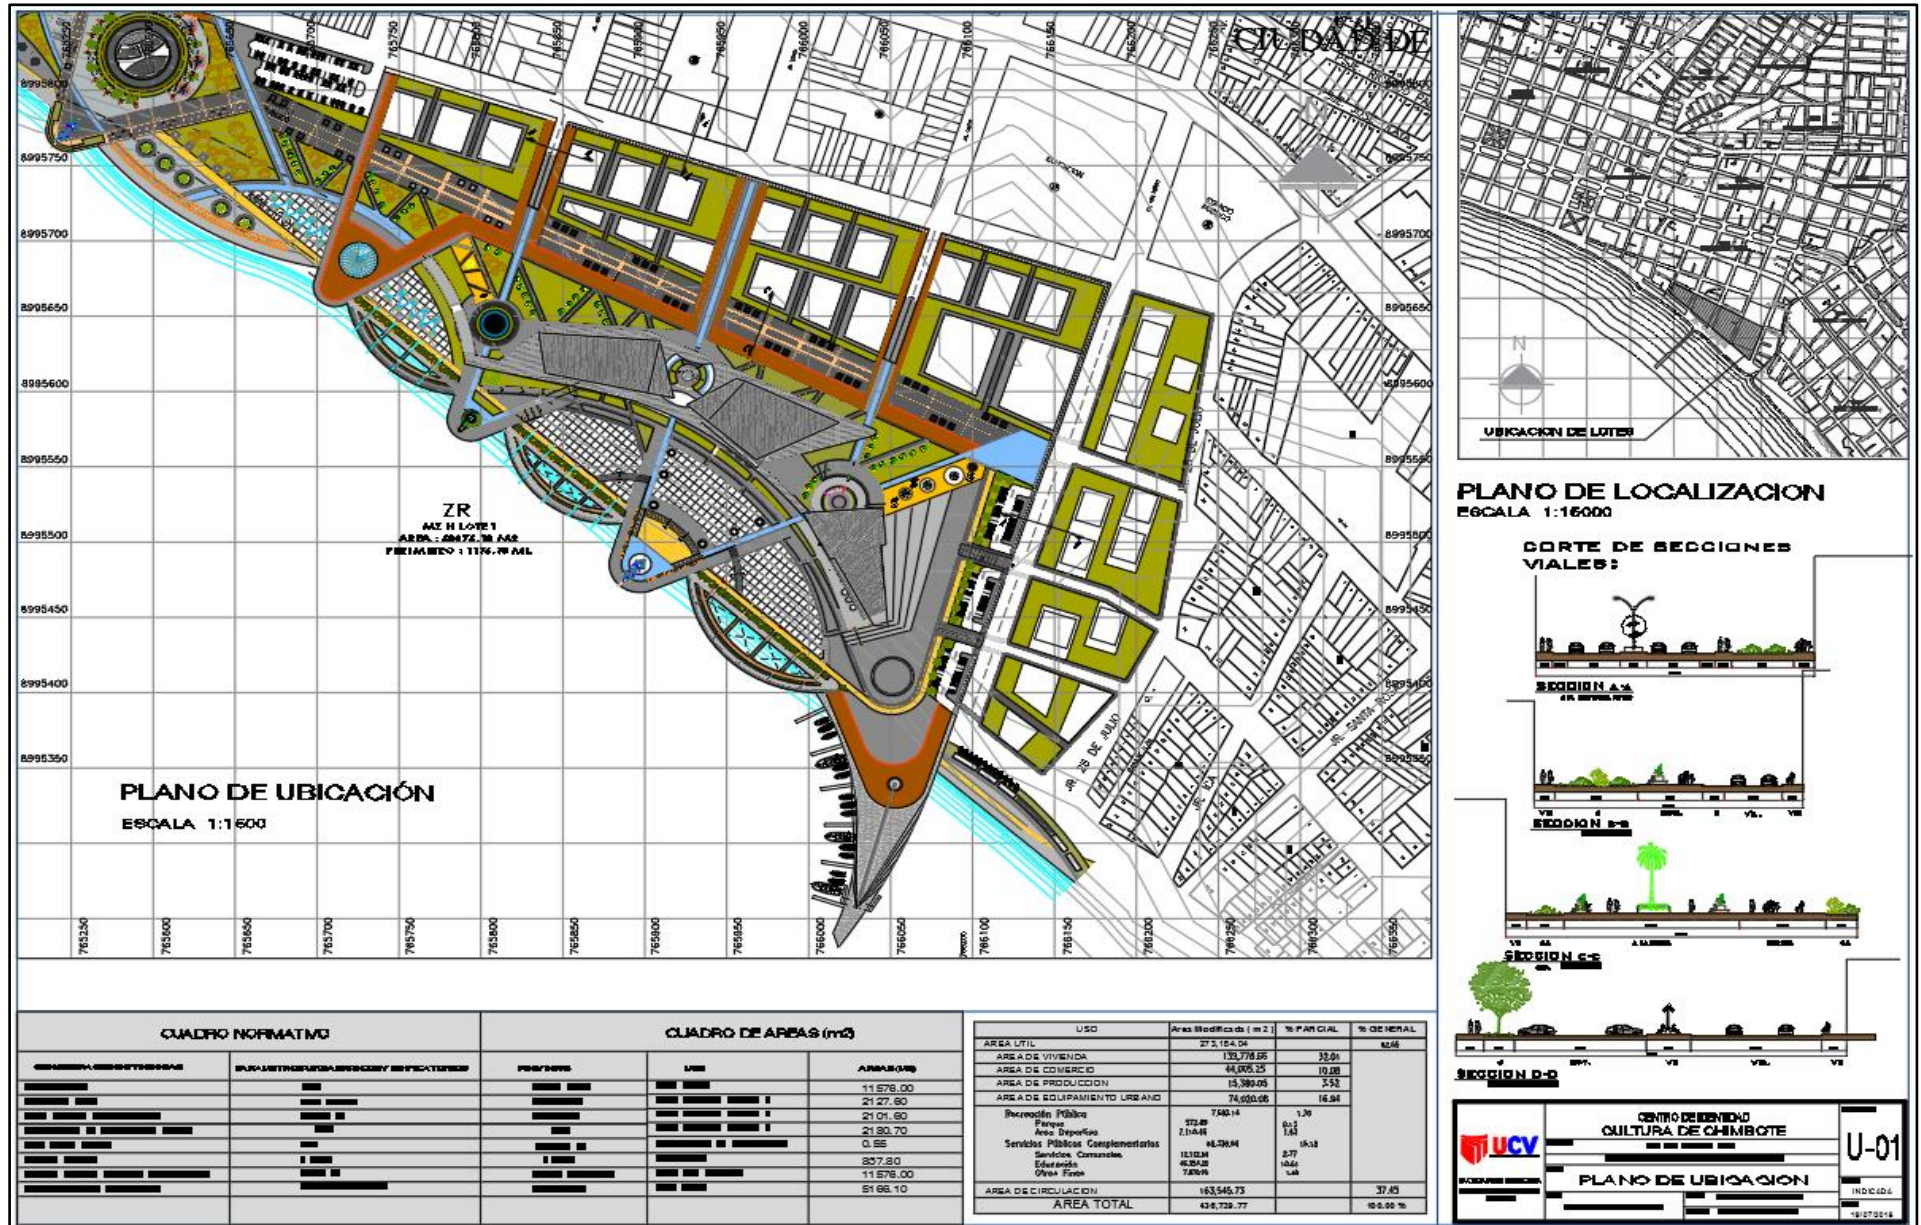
Plano de ubicación de la Bahía del Ferrol.
